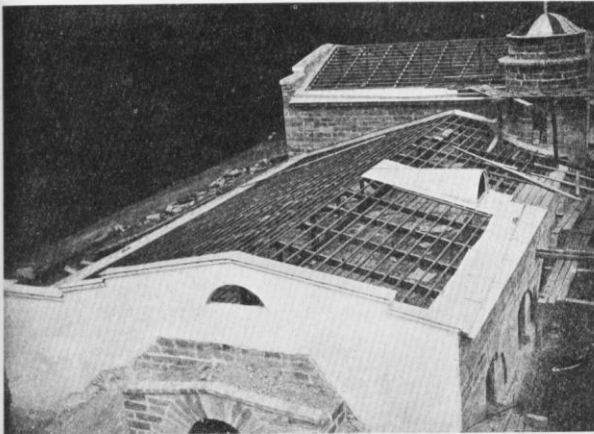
Подвалъ Станціи. Выполнены плотничныя работы по устройству крыши. Двухэтажная часть подвала перекрыта двускатной крышей съ подвѣсной системой стропиль, съ бабкой, подкосами и затяжкой. Стропила одноэтажной части — наслонныя; по стропиламъ сдѣлана обрѣшетка подъ черепицу изъ брусковъ (латъ). Выполняются кровельныя работы оцинкованнымъ желѣзомъ по покрытію ендовъ, пеленъ, надѣстныхъ желобовъ, покрытіе башни и проч.
